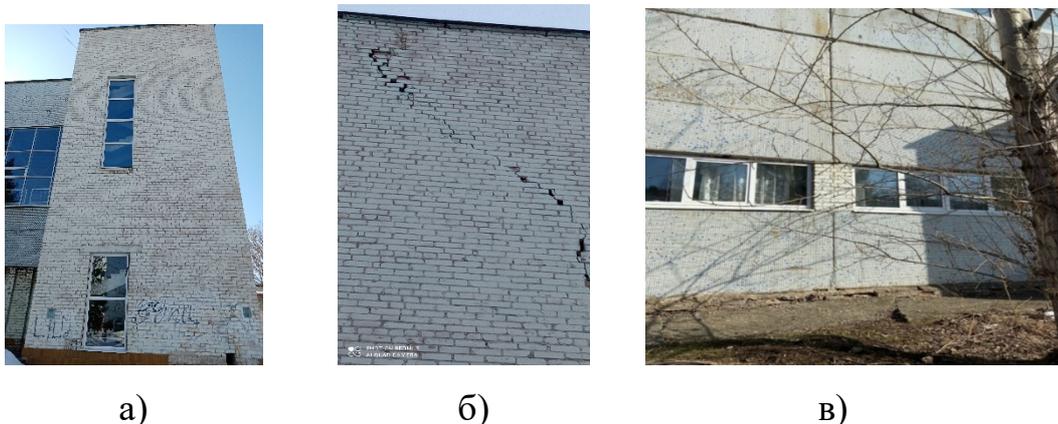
Наружные кирпичные стены (а,б) и наружные панельные стены (в)
